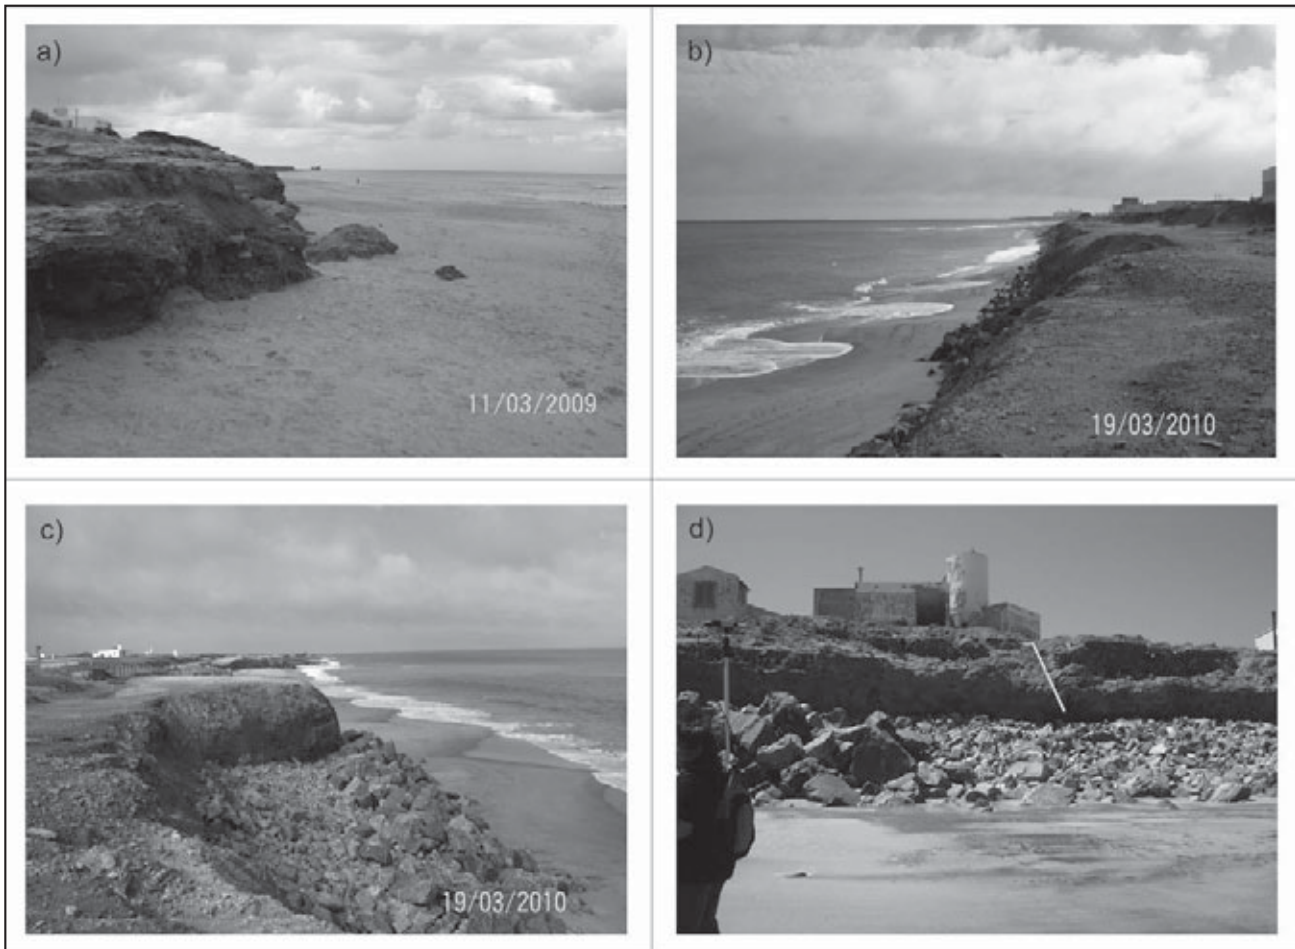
Vista de la costa y la playa: a) antes de la construcción del pedraplén, b) Vista del pedraplén desde el Perfil 6, c) Pedraplen en Perfil 5, d) Vista hacia el pedraplén y acantilado en Perfil 5.
